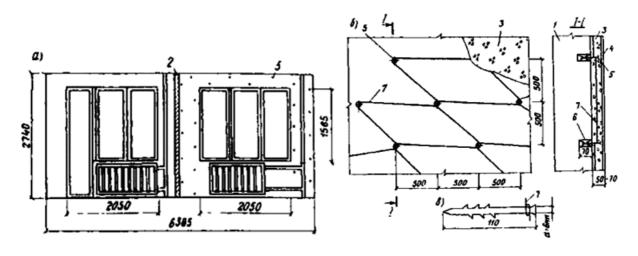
Утепление промерзающих наружных стеновых панелей устройством дополнительного утепляющего слоя керамзитобетона
